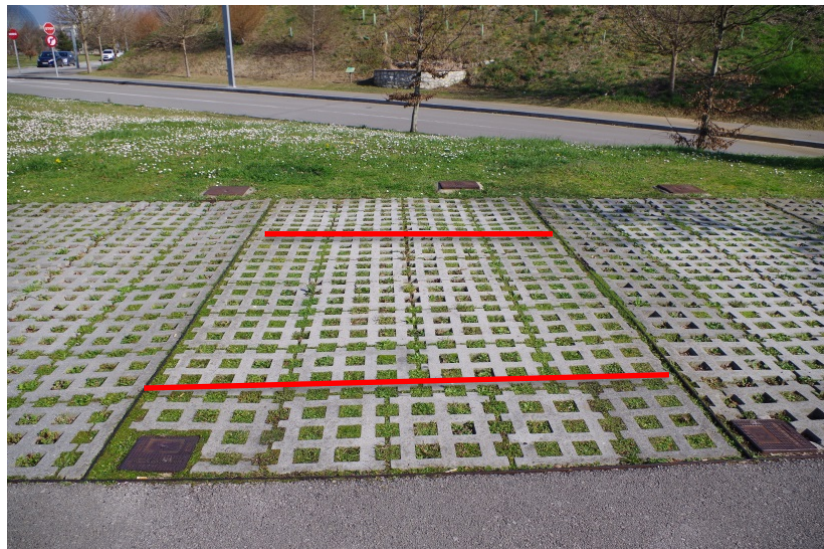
Césped reforzado por celdas de hormigón. Fuente propia
